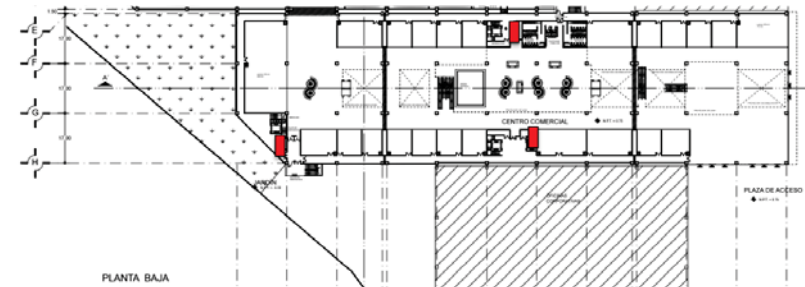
Planta baja Centro Comercial, ubicación de tableros de distribución
